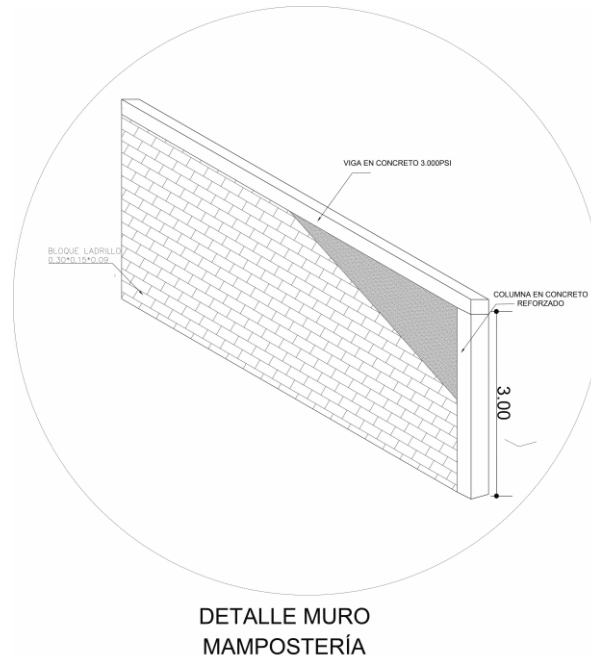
Detalle de muro en mampostería tradicional. Fuente: Elaboración propia.
